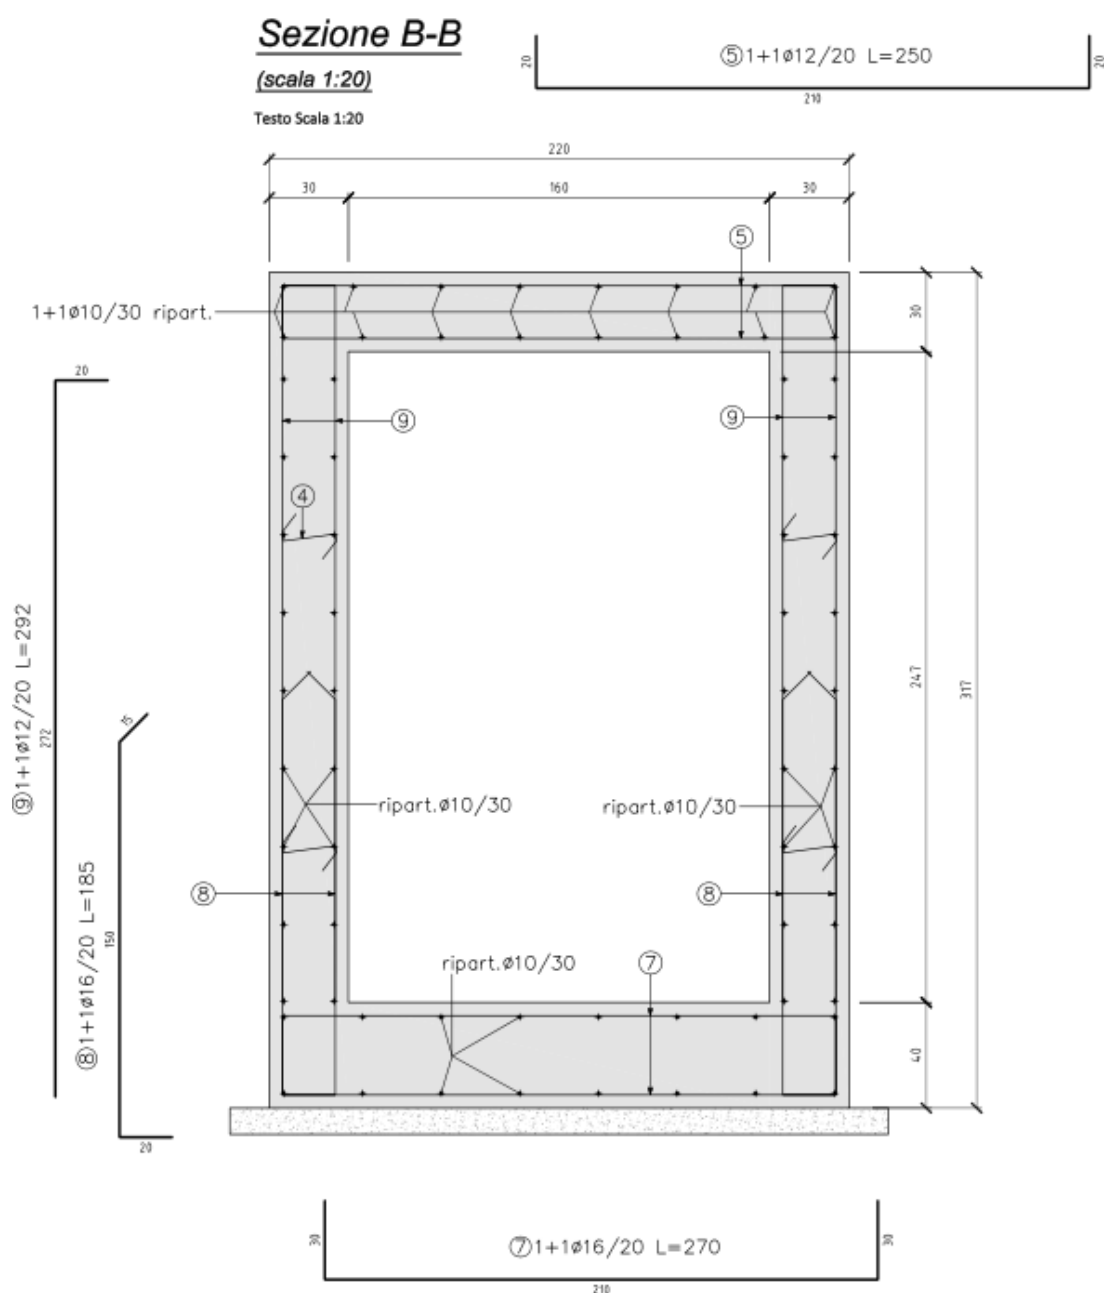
Armatura inserita sezione B-B (vedi tavola strutturale)
